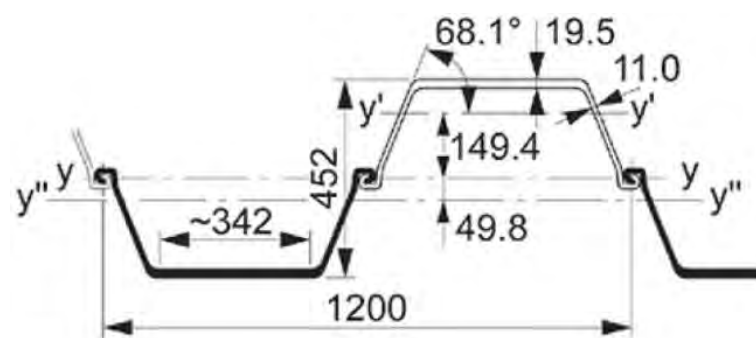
Coupe type des palplanches mises en œuvre – Source : Rapport Général d'Avant-Projet – 2016
